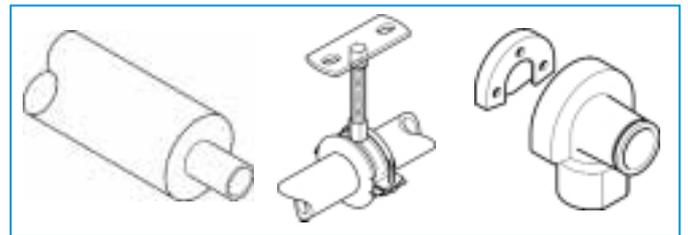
Halbschalen, Rohrschelle mit Körperschalldämmung, Armaturenanschluß mit Schalldämmung
